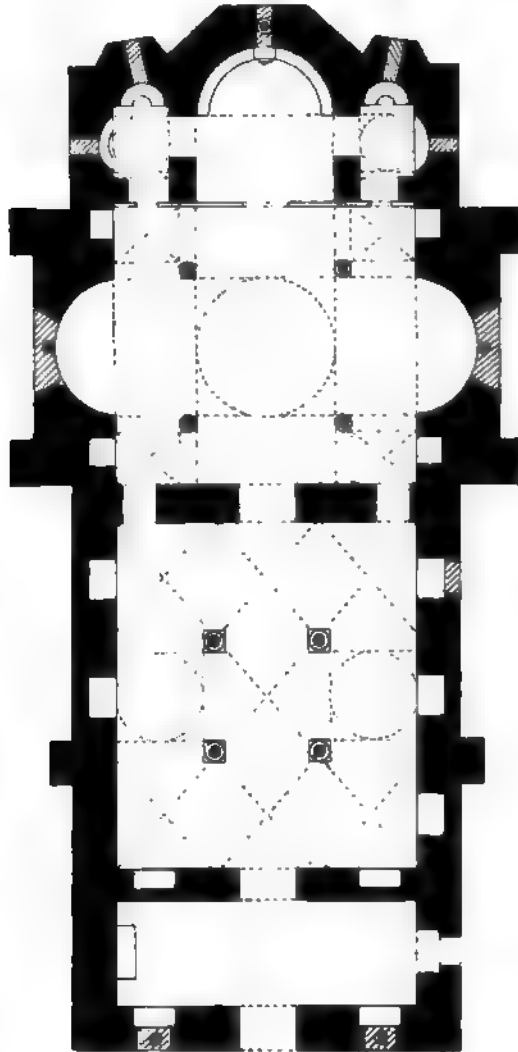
Grundriss der Klosterkirche zu Dochiarin.
